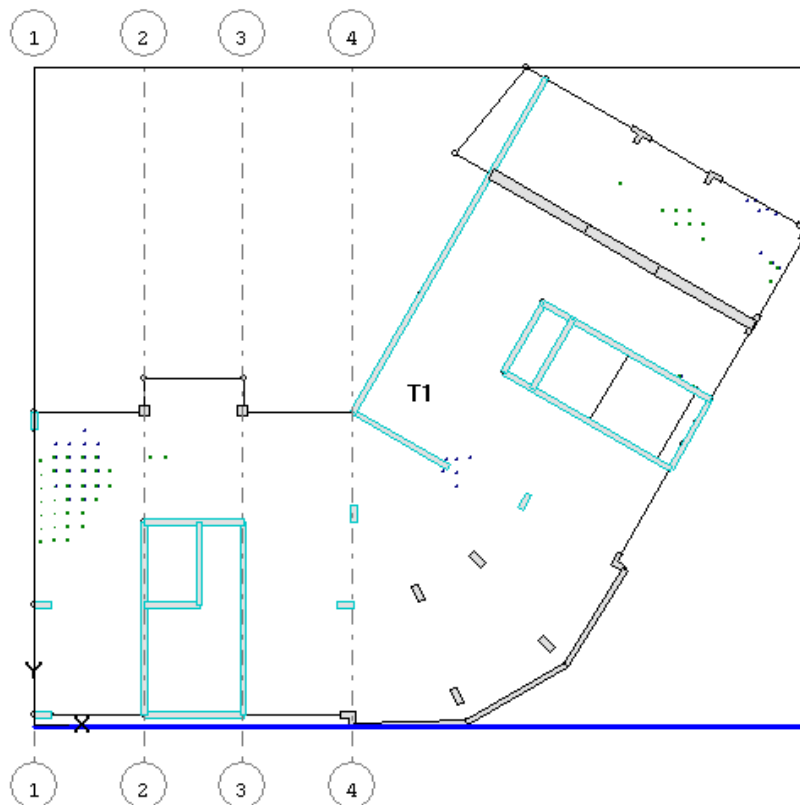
Остаточное армирование у нижней грани плиты
